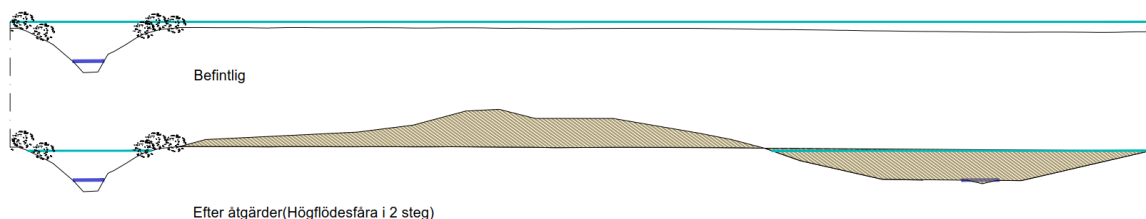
Utklipp från bilaga 2 – Illustrationsplan. Bild: Arkitema
